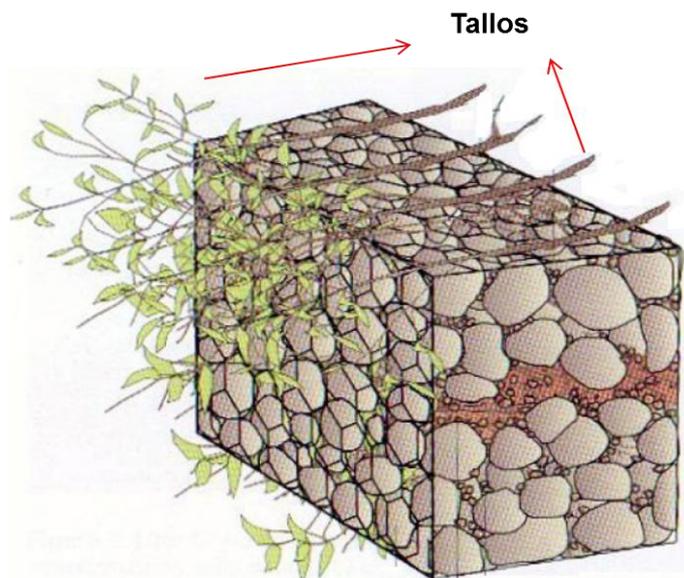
Detalle de las estructuras gavionadas con malla de alambre tejidas rellenas con piedra embolsadas y la colocación de tallos vivos o pasturas para su posterior fijación²⁵.
